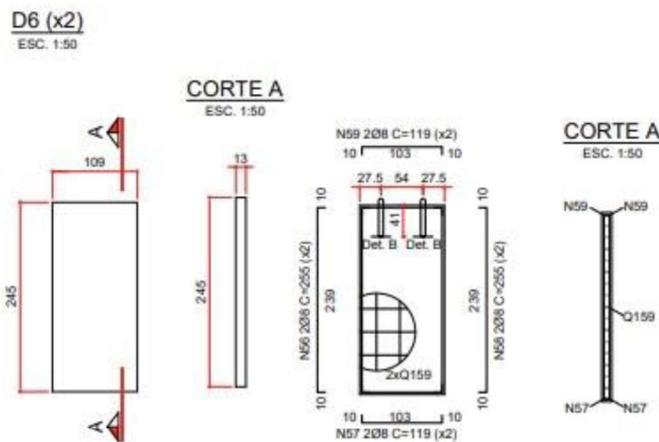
Detalhe da placa D6 do Projeto Estrutural executado
